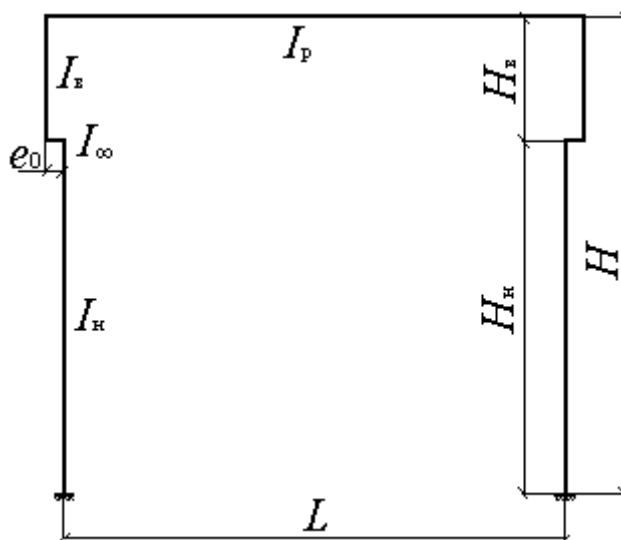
Пример расчетной схемы поперечной рамы здания (жесткое сопряжение колонн с фундаментом и колонн с ригелем)
